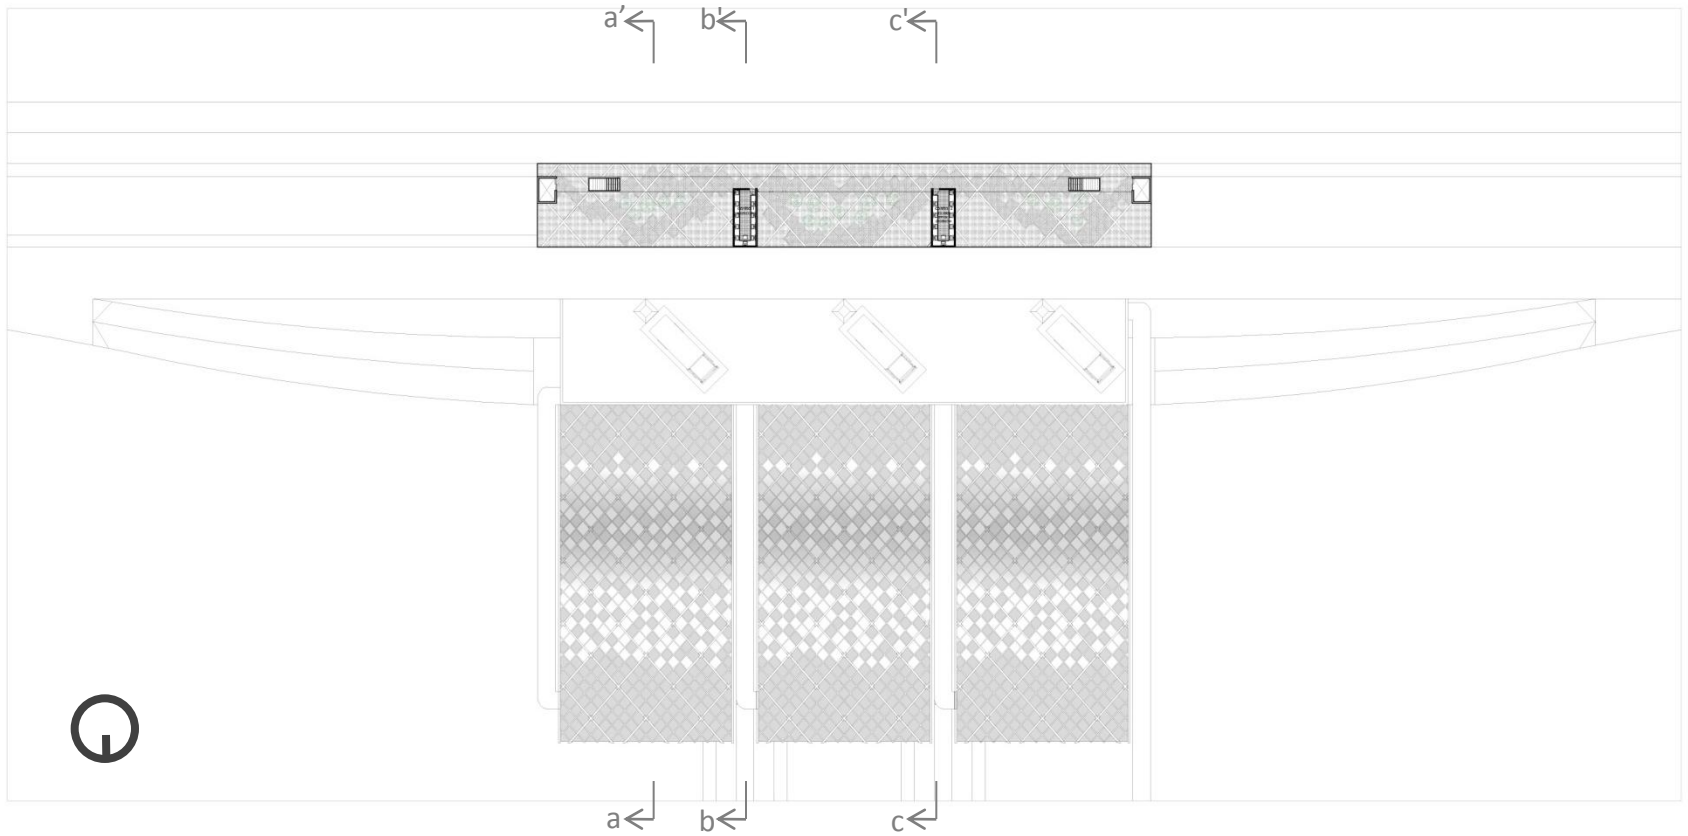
Planta nivel 2_ centros de control esc 1:800
